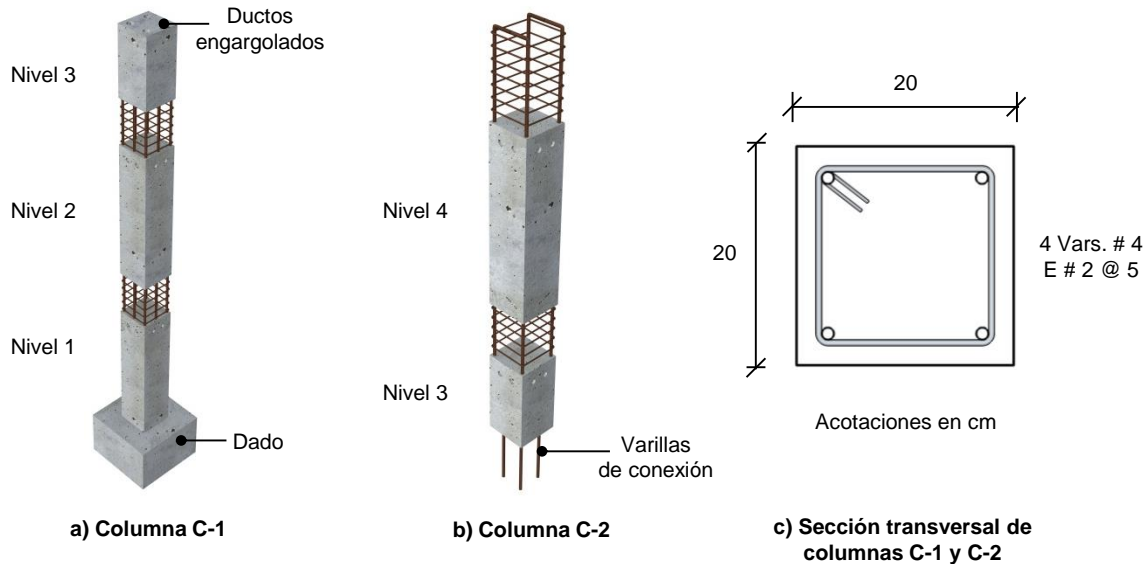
Vista en isométrico y sección transversal de columnas tipo
